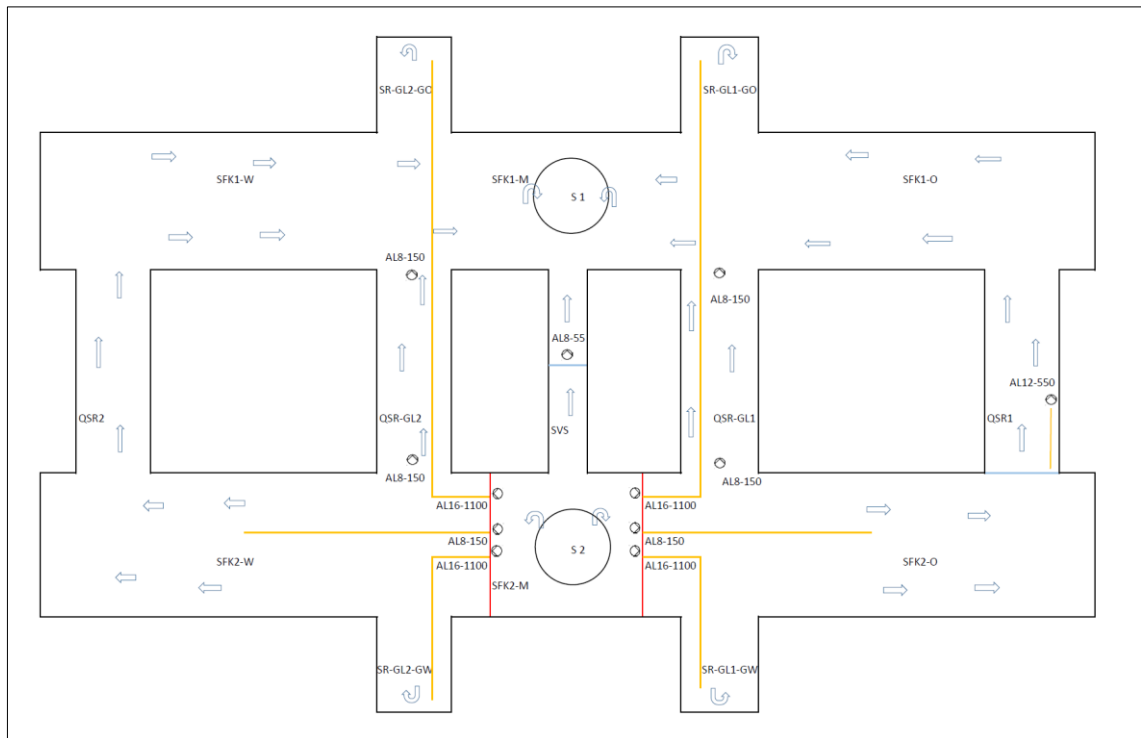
Grundriss Umluftsystem in den Schachtfußkavernen Phase 4
